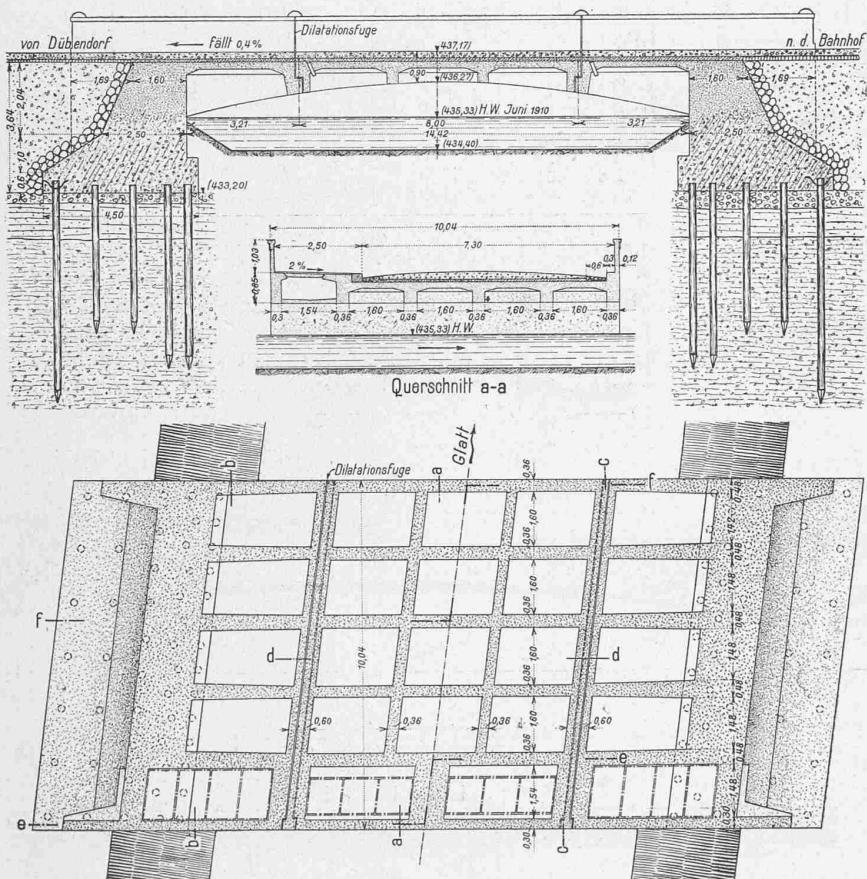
Glattbrücke bei Dübendorf. Längsschnitt und Querschnitt a-a. Horizontalschnitt unter der Fahrbahnplatte mit Grundriss. — Maßstab 1:200.
